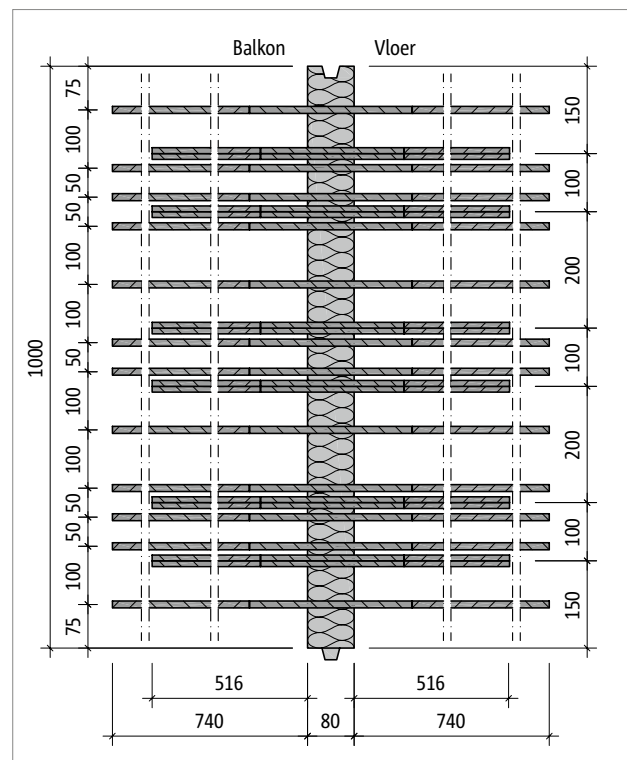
Schöck Isokorf® T type D bij CV35: Zijaanzicht
